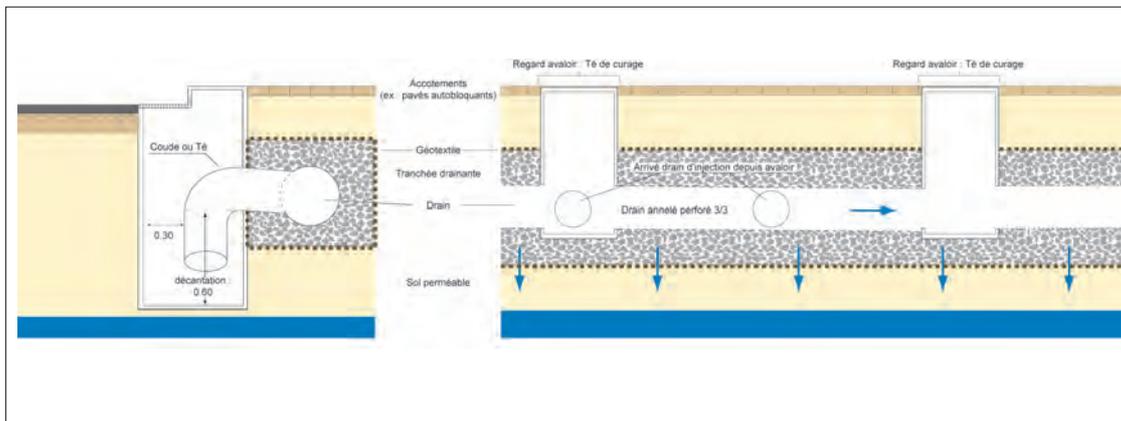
Coupe en travers et profil en long d'une tranchée drainante/d'infiltration.
